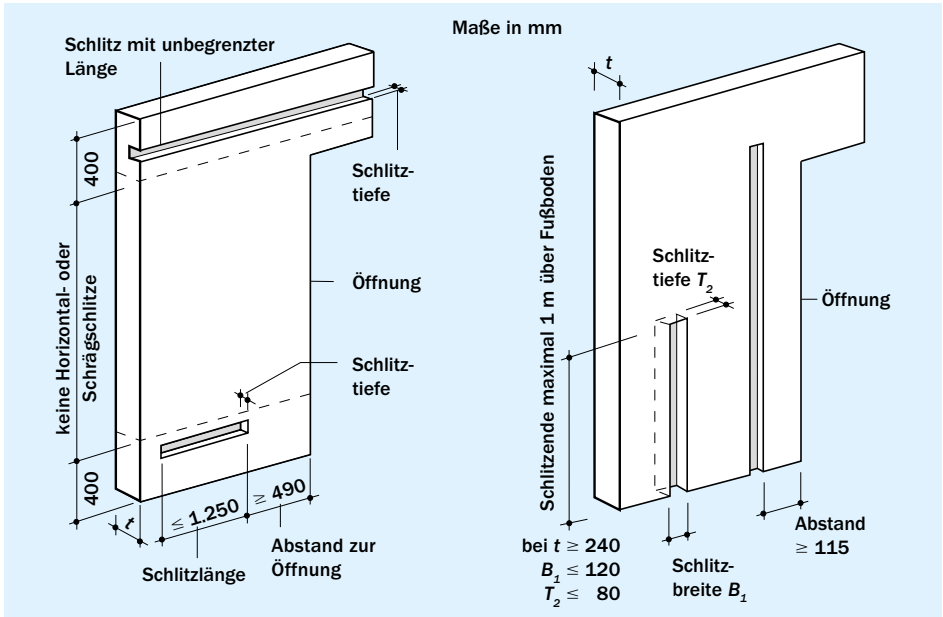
Nachträglich hergestellte horizontale und schräge Schlitzte (links); nachträglich hergestellte vertikale Schlitzte und Aussparungen (rechts)
